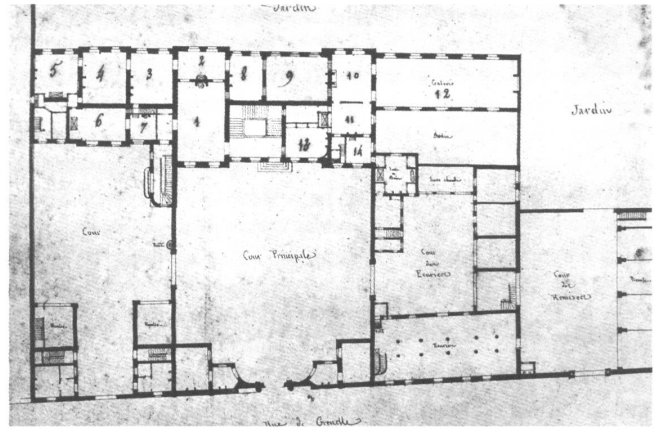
Hôtel de Villars, Grundriss Erdgeschoss, Paris, Architekt der Galerie Jean Baptiste Le Roux, 1731.
